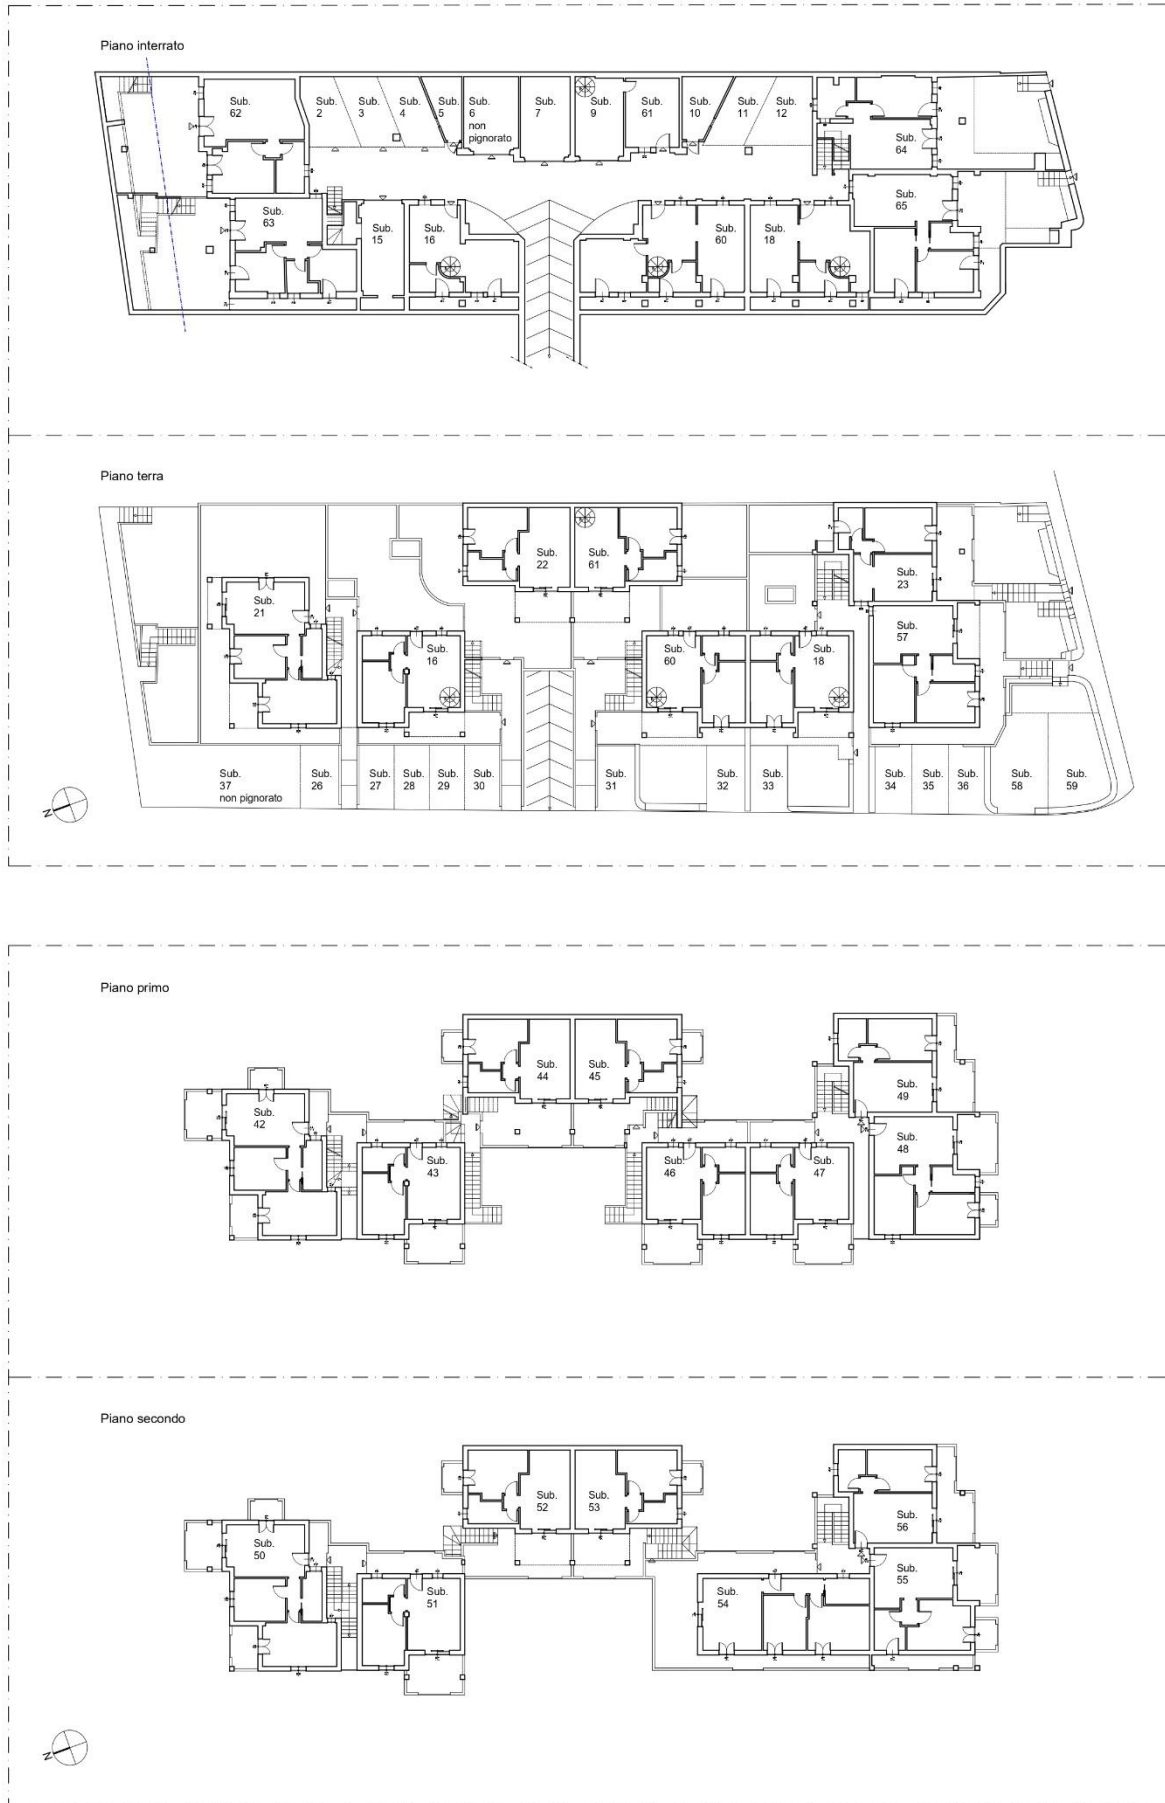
Planimetria stato di fatto rilevato dei beni oggetto di procedura esecutiva ubicati al piano interrato, al piano terra, al piano primo e al piano secondo
